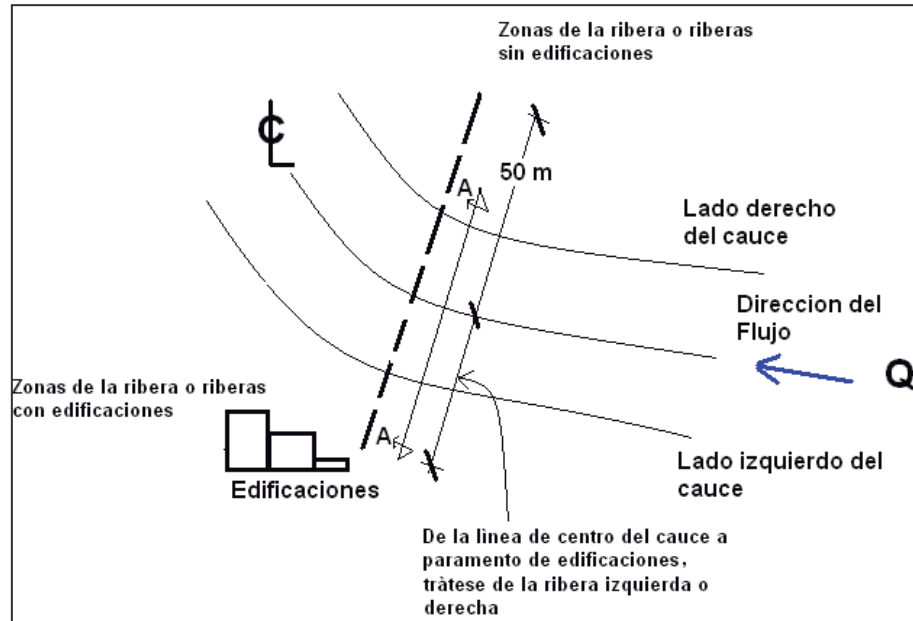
Lineamientos para el levantamiento de secciones transversales. Planta.
